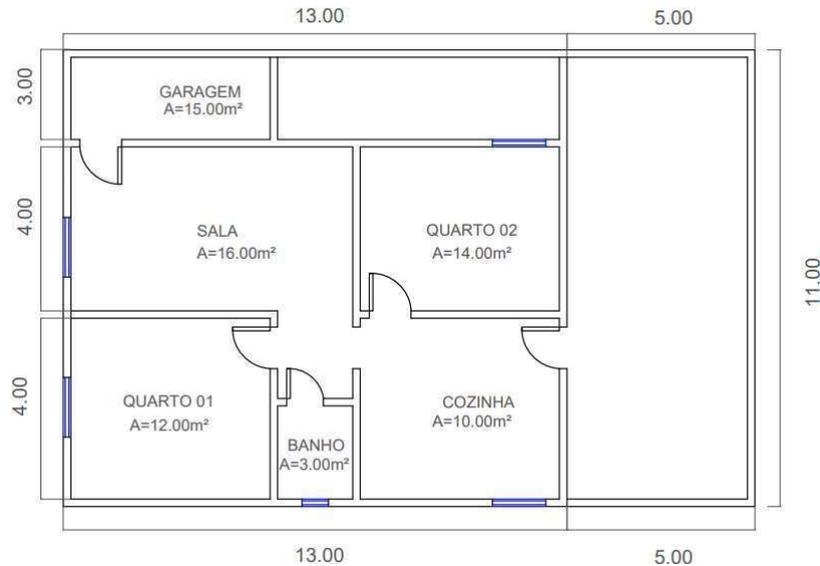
Planta baixa de edificação residencial térrea (Autor, 2023).
